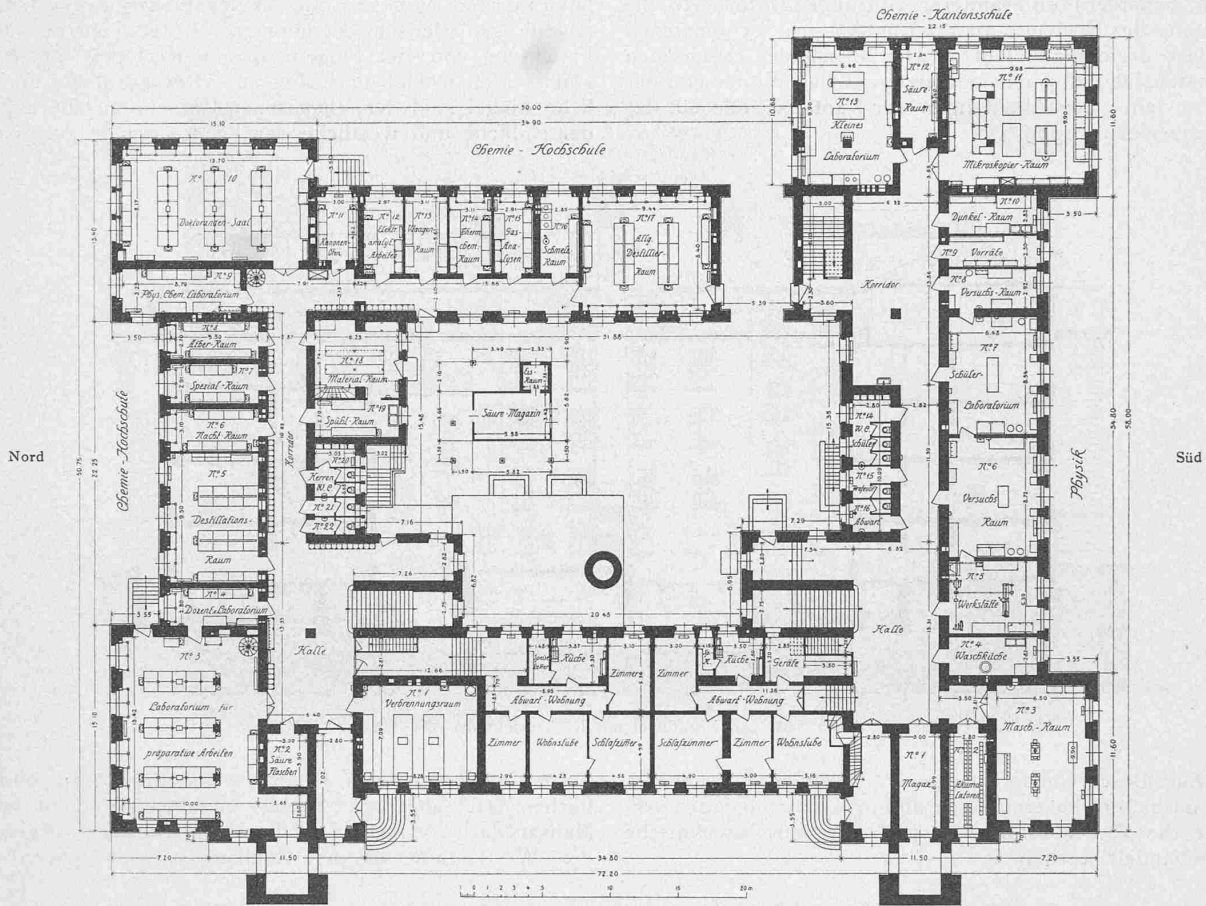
und 4. Grundrisse vom Heizgeschoss und vom Untergeschoss. — Masstab 1 : 500.
